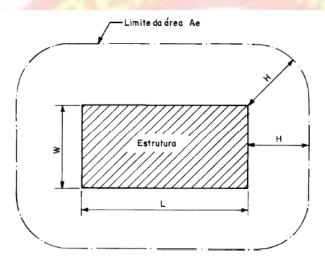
Delimitação da área de exposição equivalente (Ae) - Estrutura vista de planta
